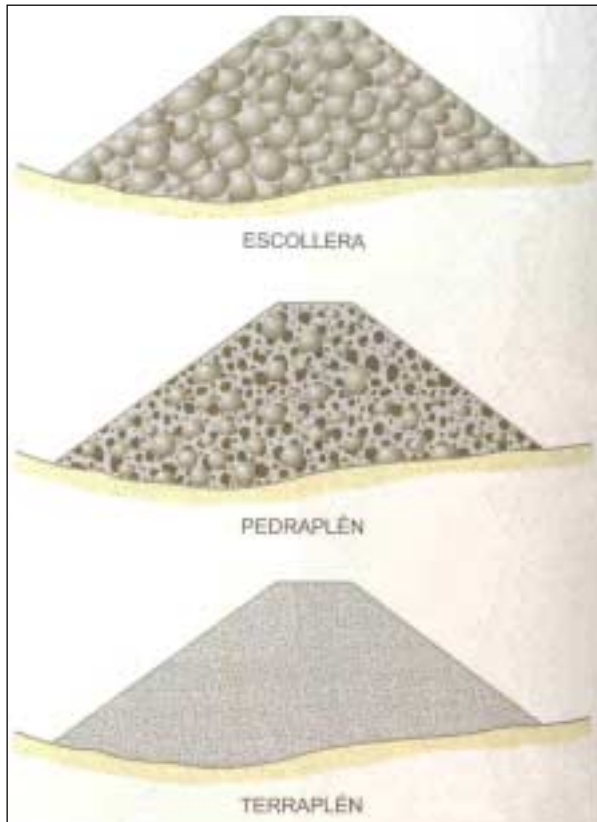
Tipos de Rellenos (modificado de Dapena, 2000)
